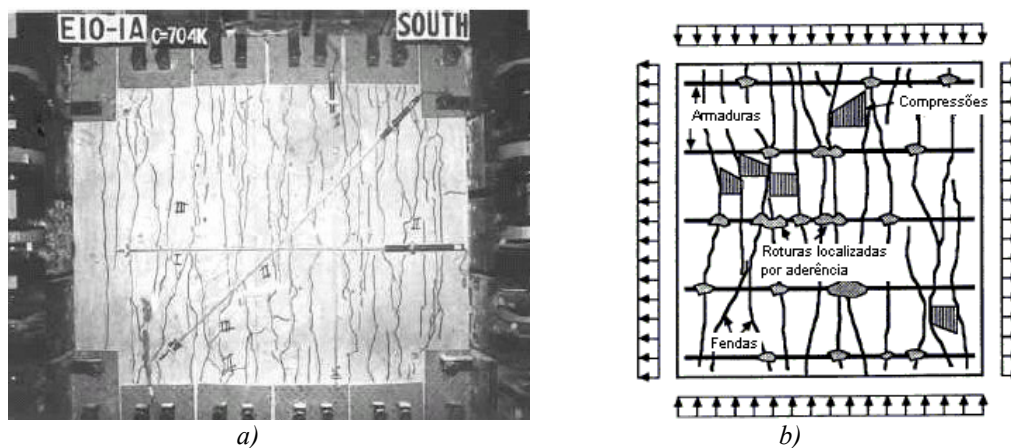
a) Padrão de fendilhação de um painel de betão armado sujeito a um estado de compressão-tracção. b) Excentricidade das tensões nas escoras (Belarbi e Hsu 1995).
